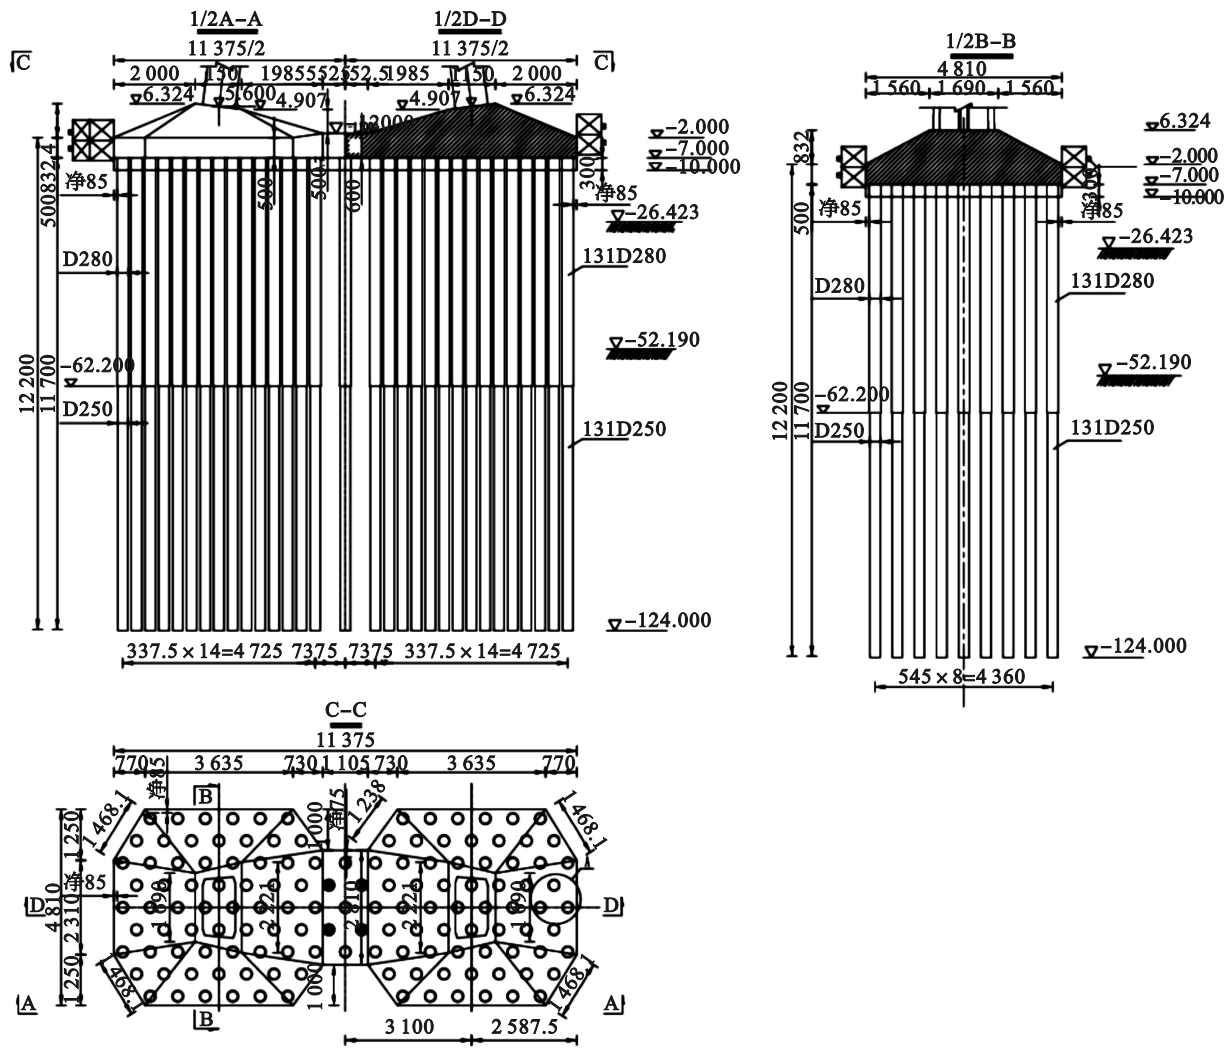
苏通大桥群桩基础构造和平面布置(高程单位:m,尺寸单位:cm)
